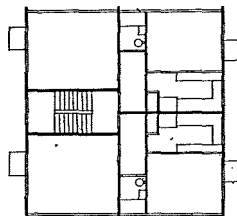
Lejlighedsplan i helstøbt Betonhus. Maal 1:400.
